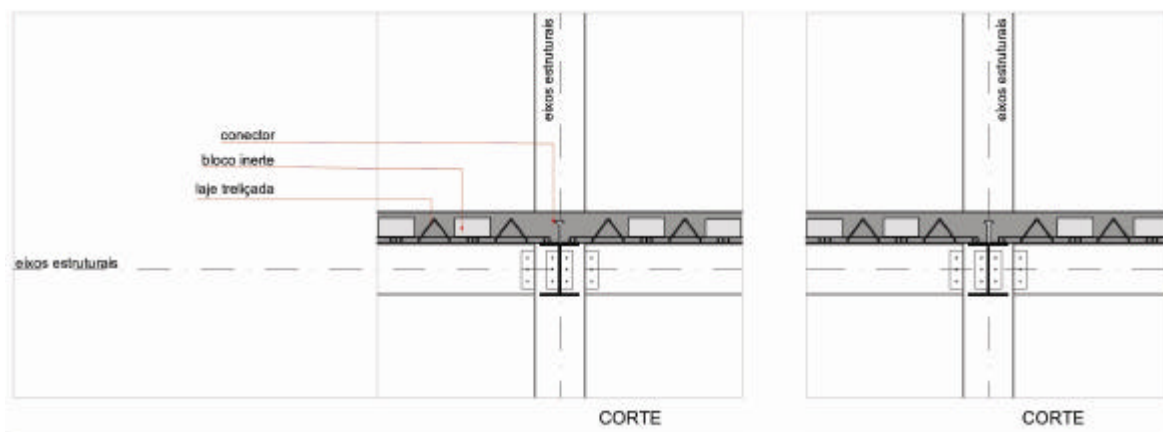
Detalhe construtivo - pré lajes de concreto – Lajes treliçadas.
